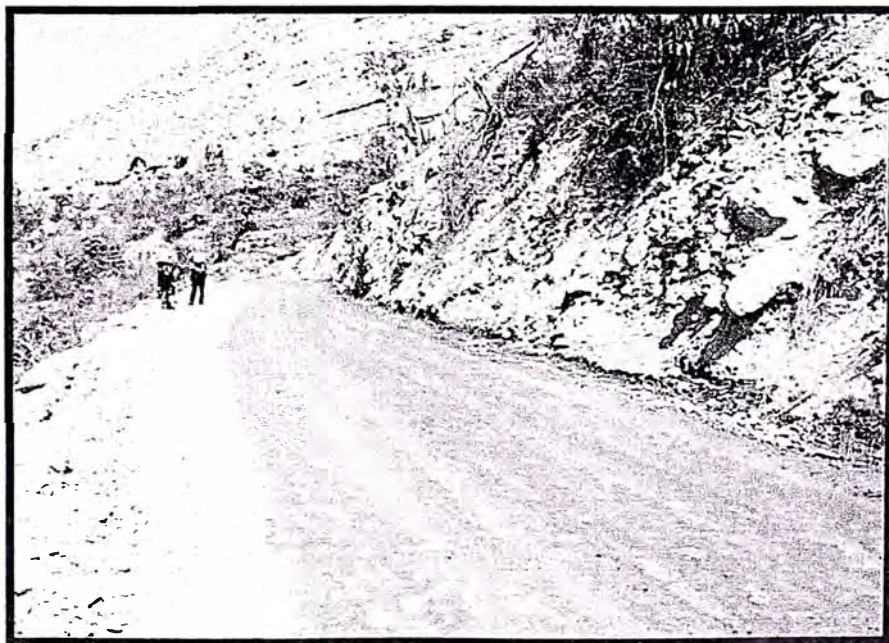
Otra vista de la carretera en su actual estado, en la margen izquierda se construirá el futuro muro de contención.
